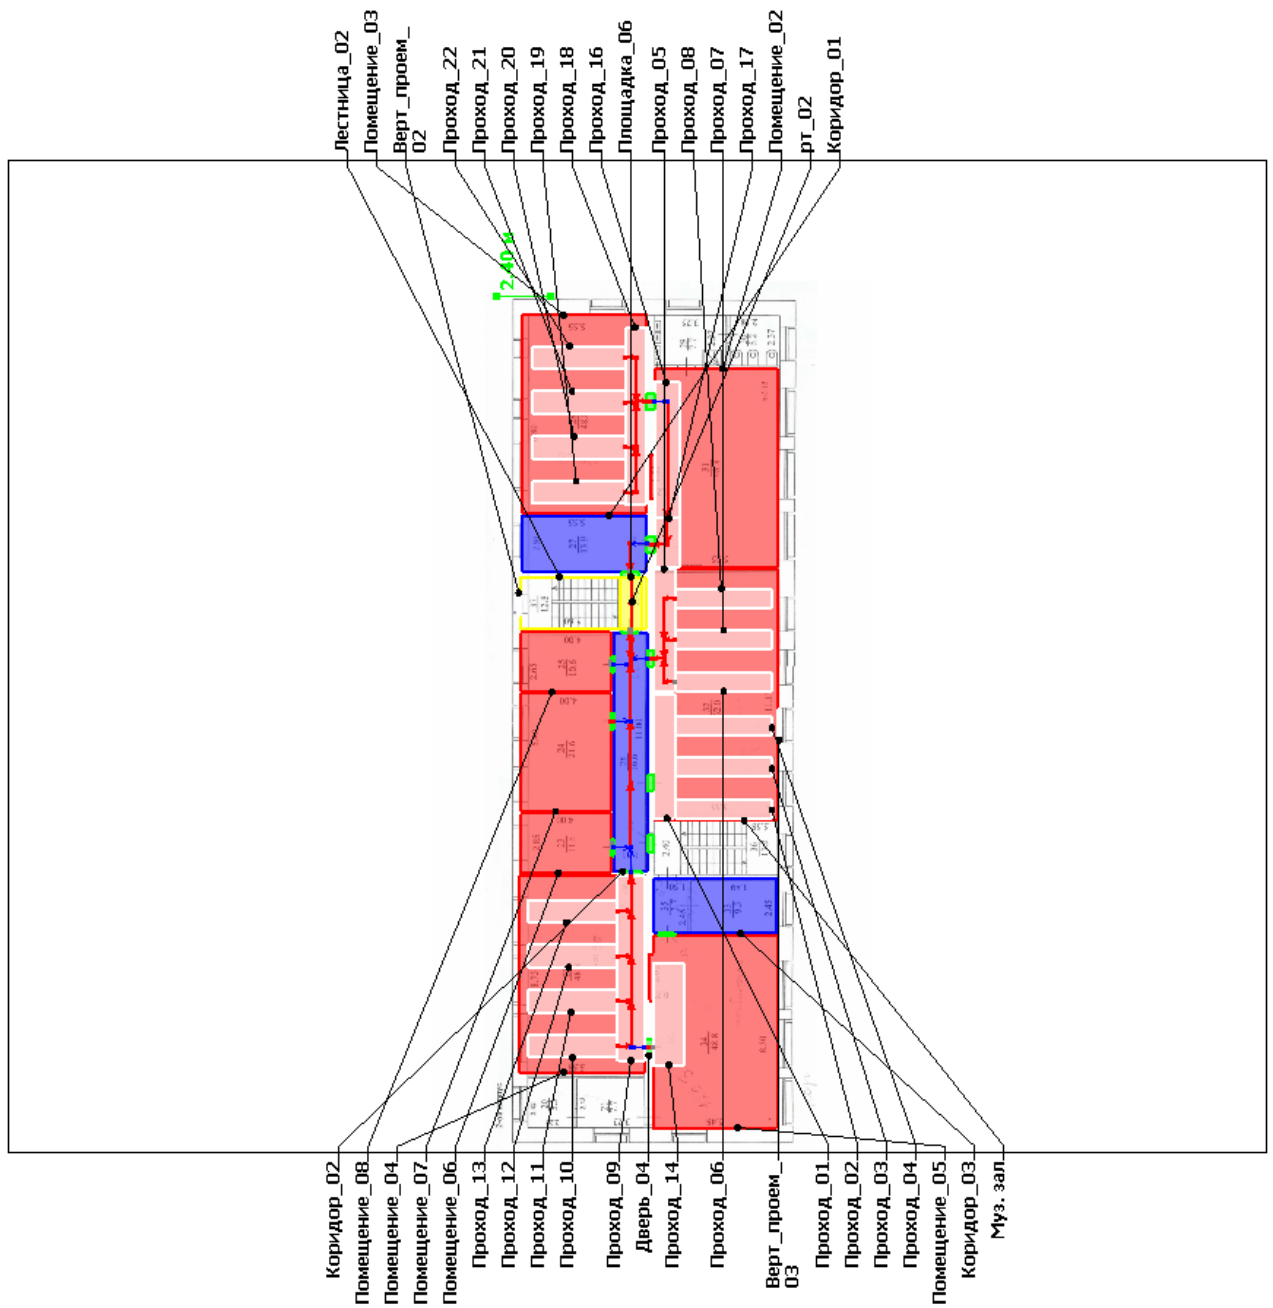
Расчетная схема эвакуации. Этаж 02
